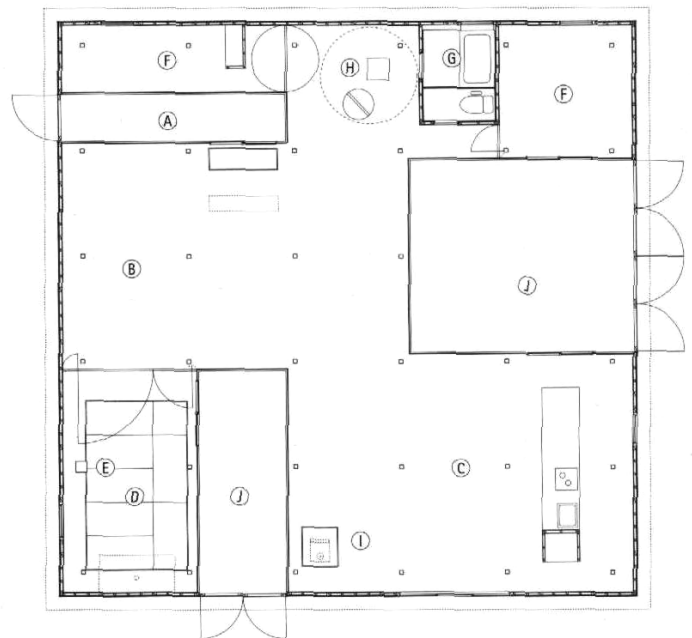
Planta: los patios articulan la rígida geometría del espacio (A: patio de entrada; J: patios).
